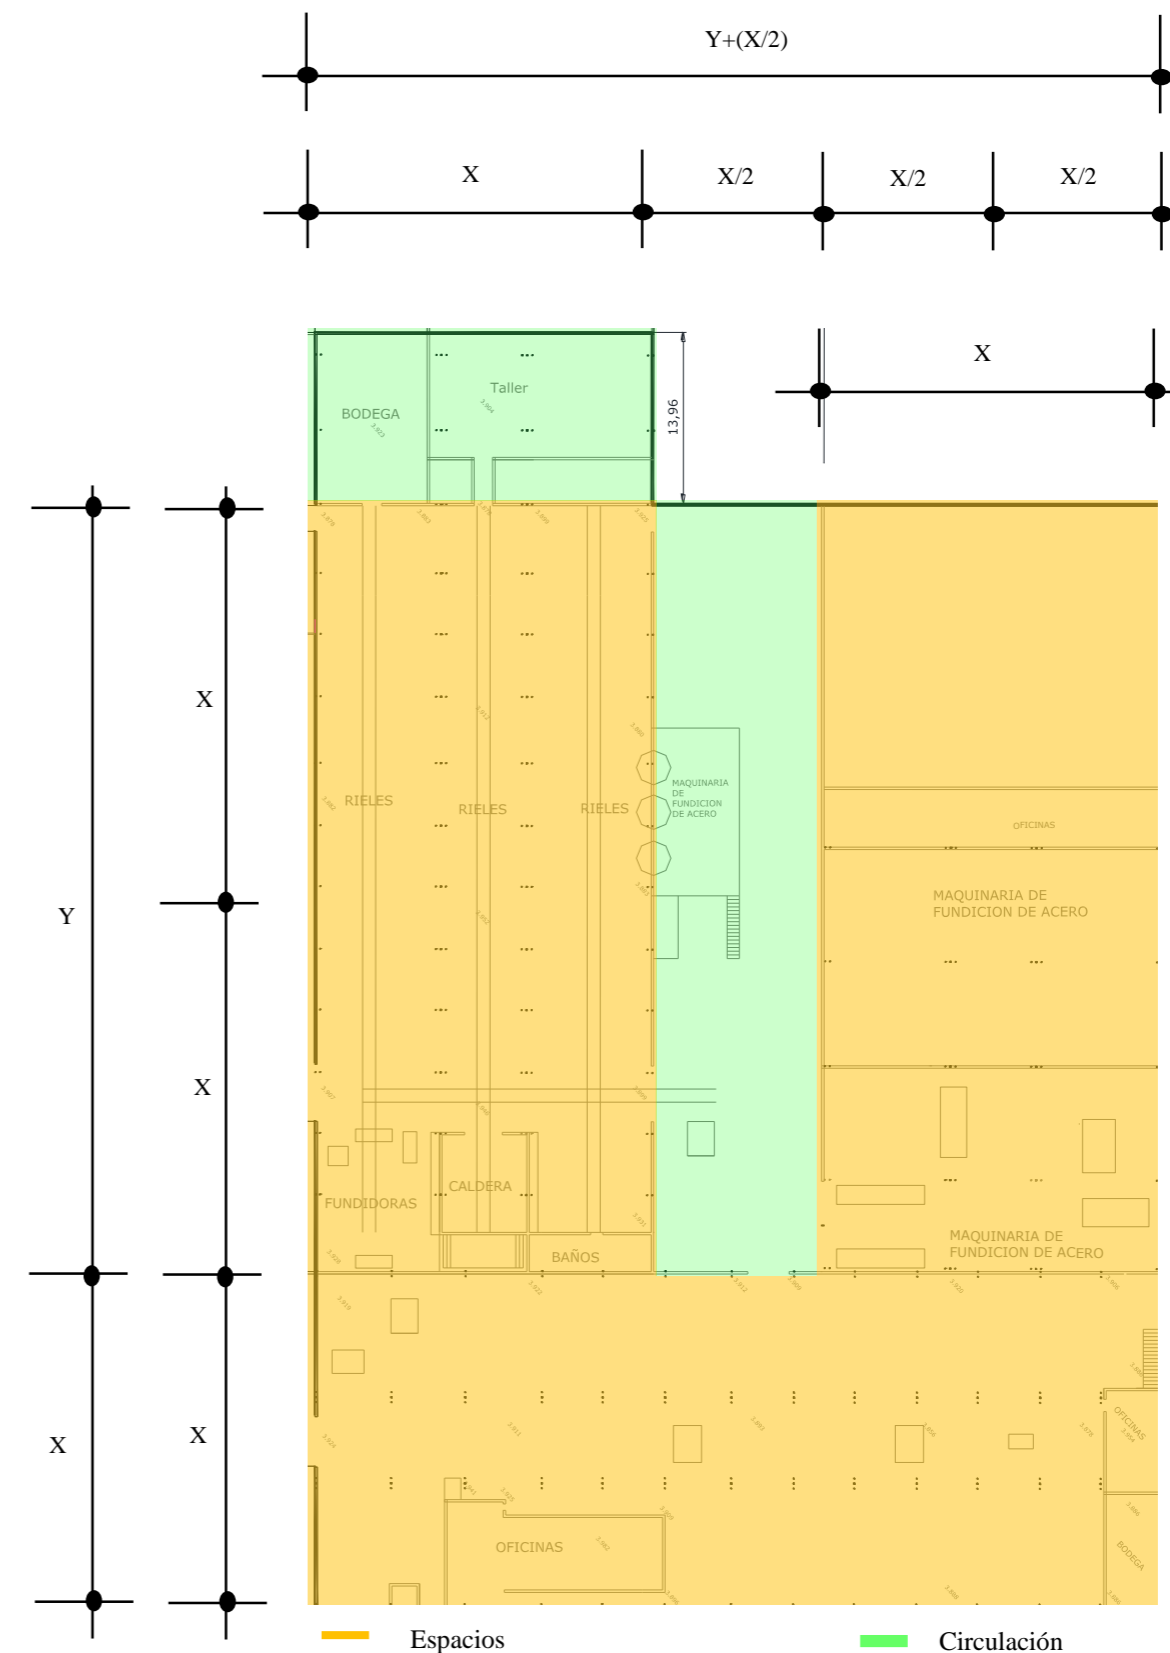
Plano de proporciones del terreno a intervenir – Estado actual.
